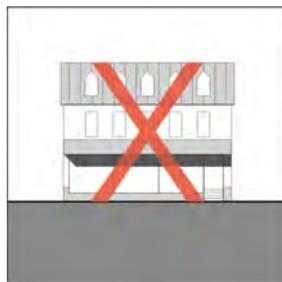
Ladenzone abgetrennt vom Obergeschoss
